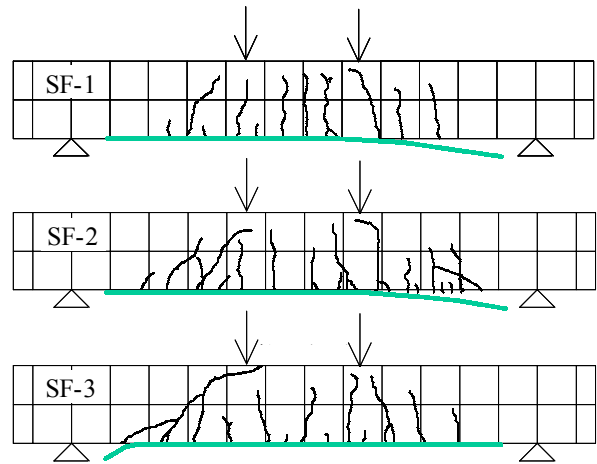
ひび割れおよびシート剥離状況（終局時）
